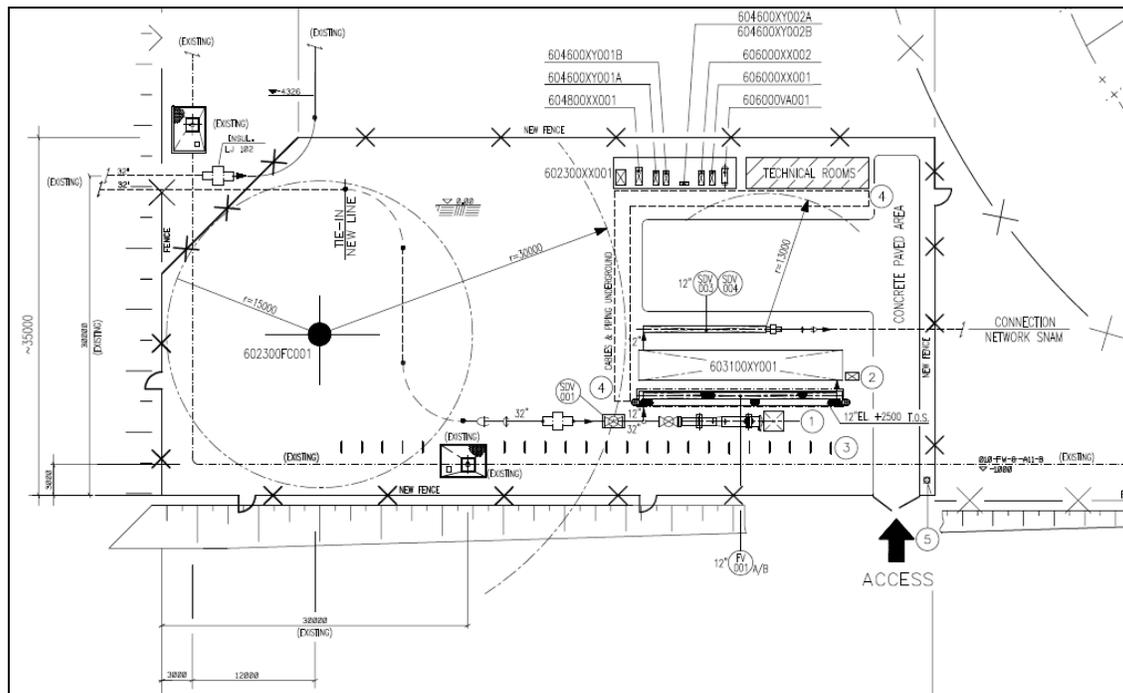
area di progetto e layout delle facilities (riportate in dettaglio in Allegato 4)
